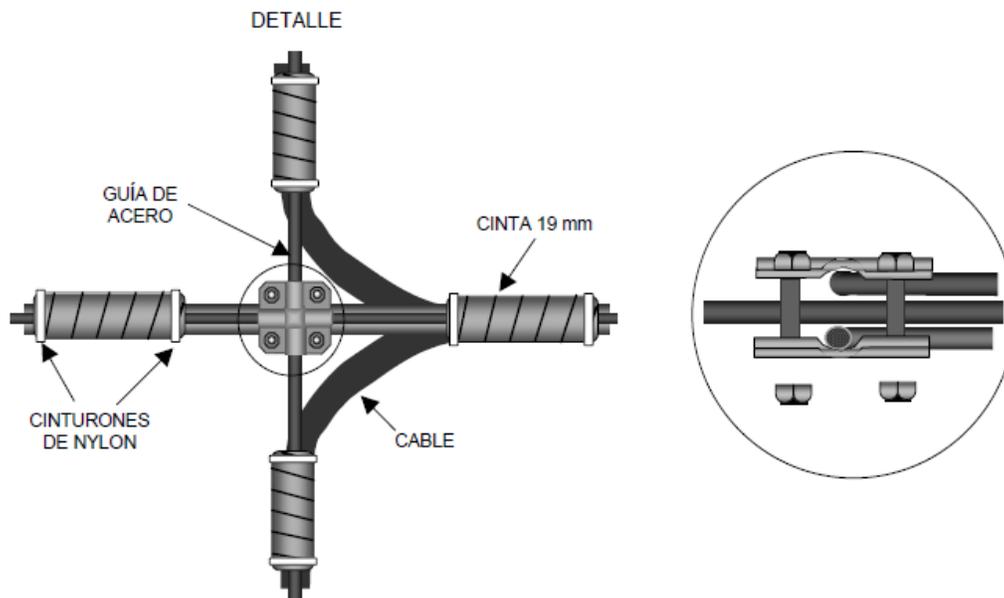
Detalle de instalación de las guías de acero, en el Crucero para Cable Mensajero.
